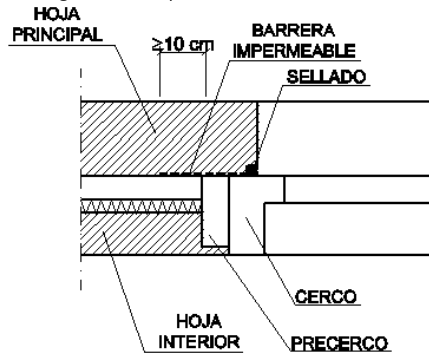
Ejemplo de encuentro de la fachada con la carpintería
